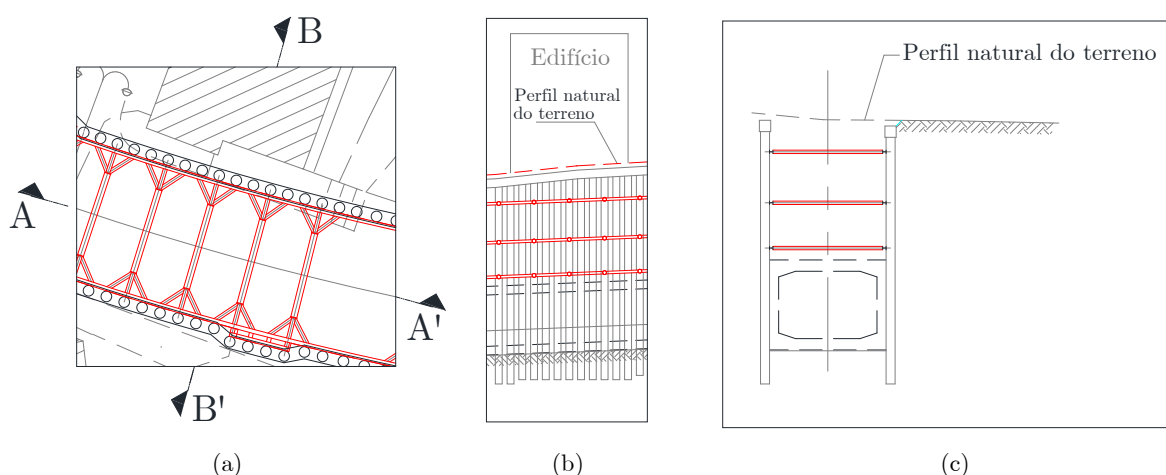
(a) Extrato da planta na zona do escoramento metálico; (b) Corte longitudinal A-A'; (c) Corte transversal B-B'.
